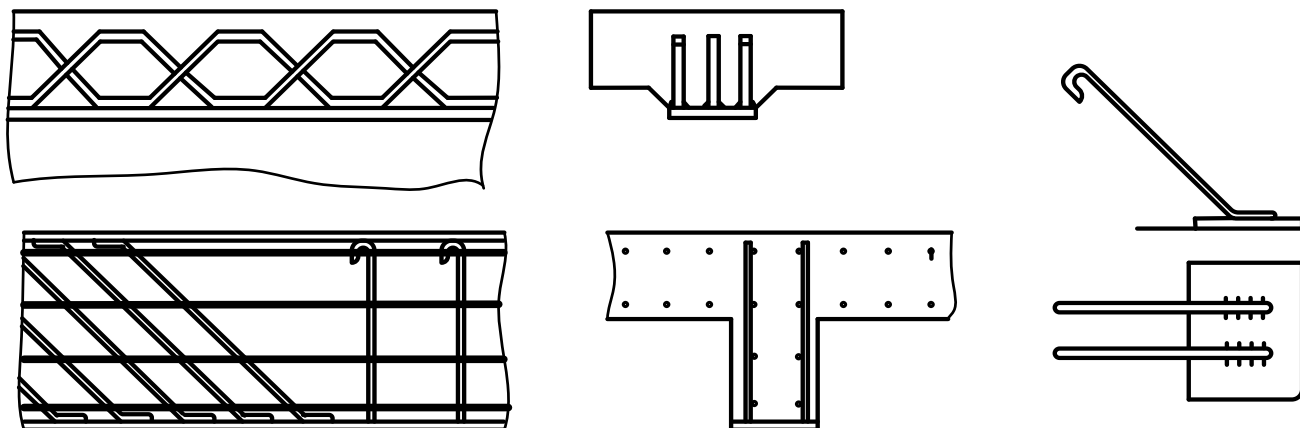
Окремі деталі, які приварюються за допомогою ручного зварювання
